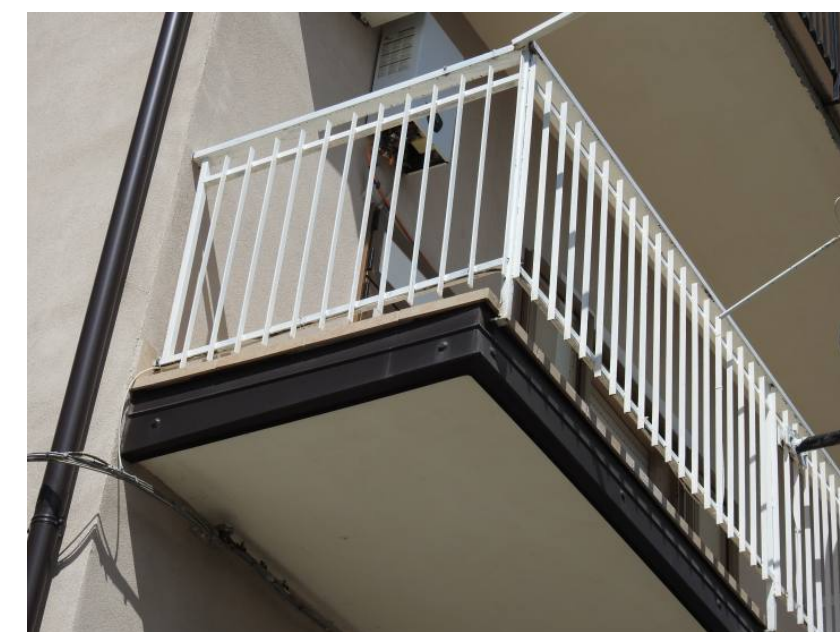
Vista dal basso dell'intradosso del balcone del primo piano di cui alla Foto N°46 e del frontale rivestito con scossalina in lamiera dopo i lavori di ripristino
